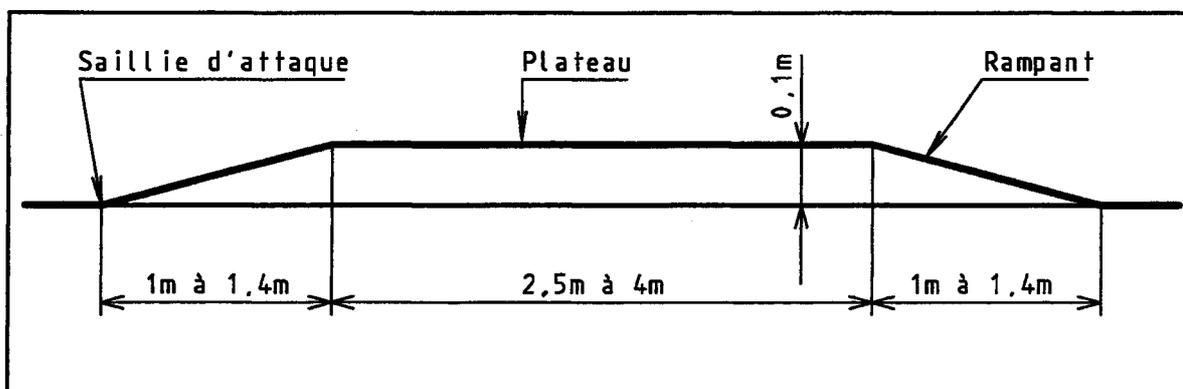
Profil en long du ralentisseur de type trapézoïdal
